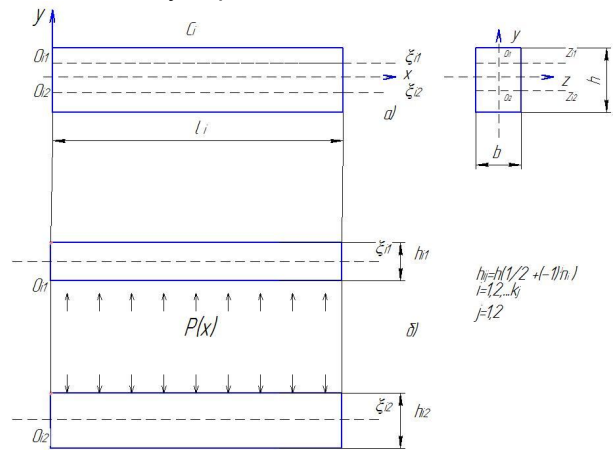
Расчетная схема i -го сегмента балки: а – цельная балка; б – две части балки, соединенные поперечными связями
